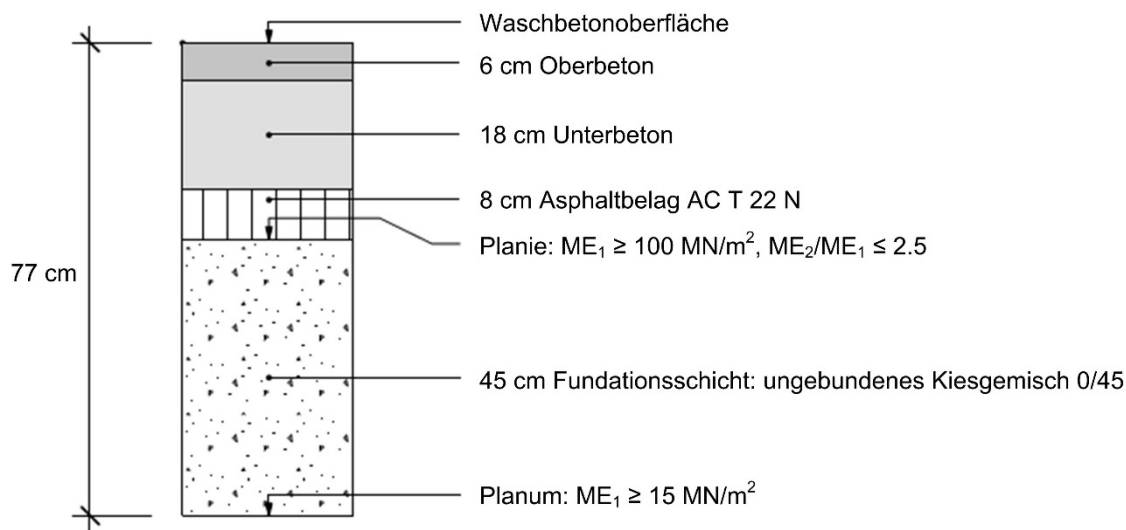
Aufbau Beton in Splittbeton mit Waschbetonoberfläche (2-schichtig)
